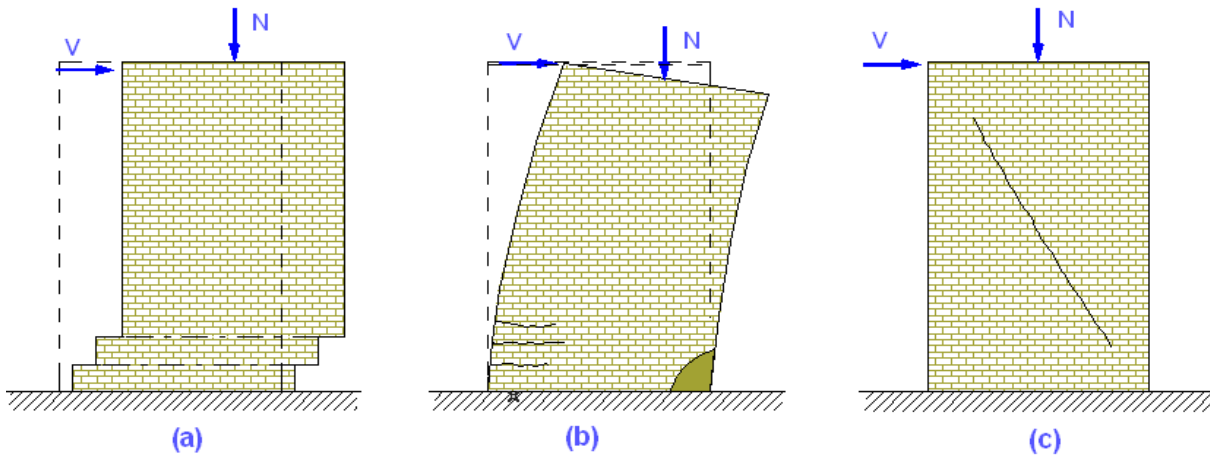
Modes de rupture d'un mur en terre s soumis un chargement dans le plan.
